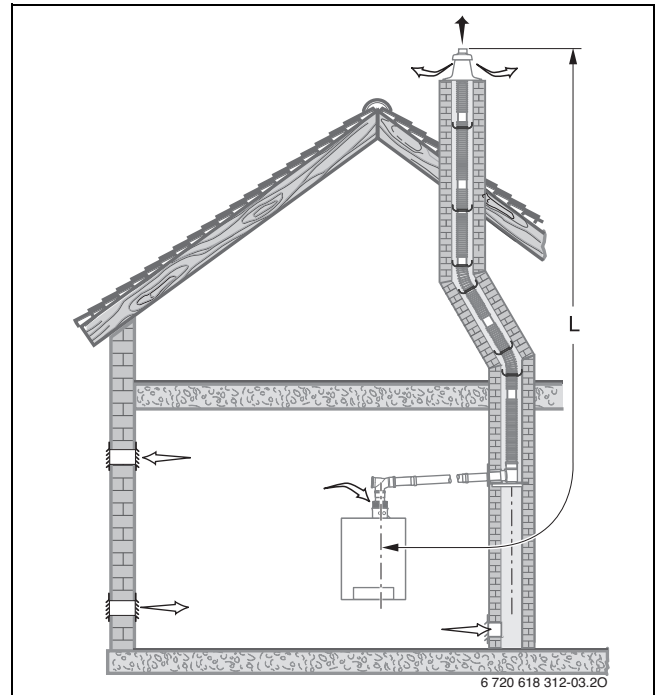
B₂₃: Abgasführung über hinterlüftete flexible Abgasleitung Ø 100 mm im Schacht
